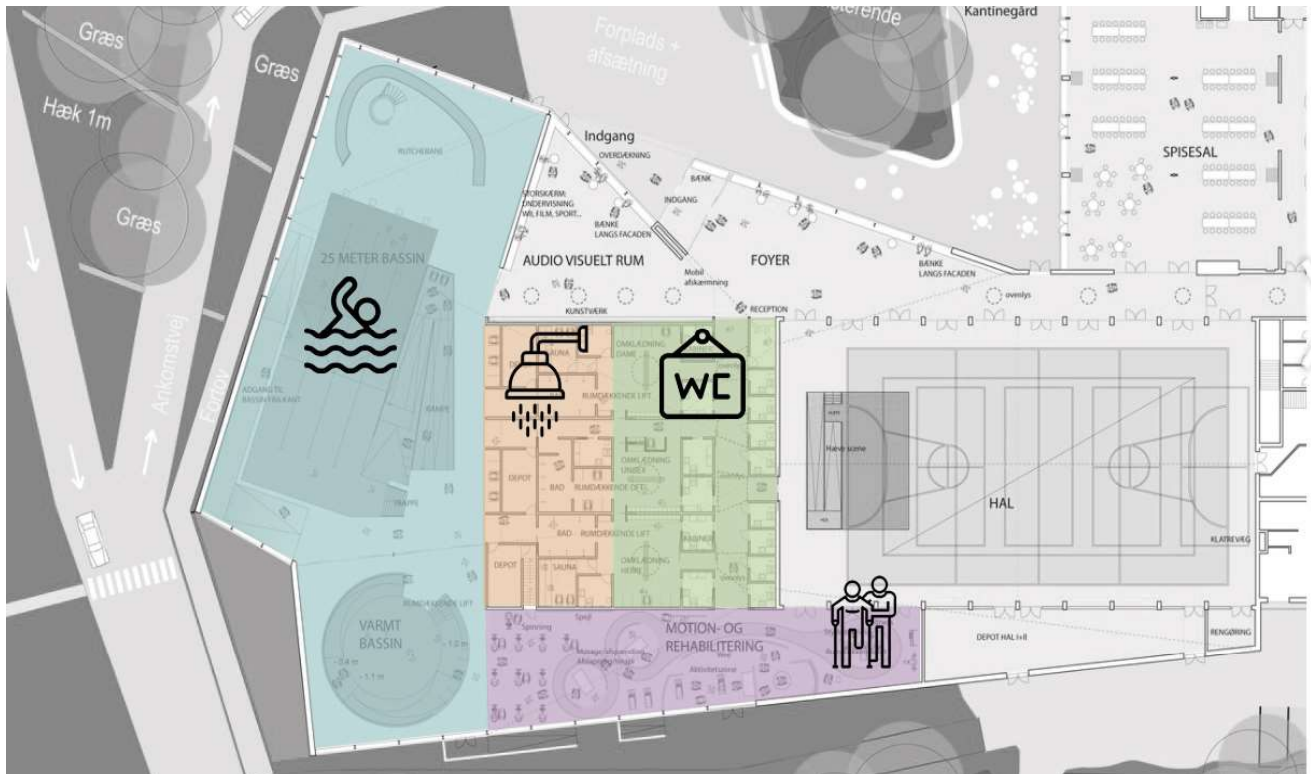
Planta arquitectónica de proyecto Centro de rehabilitación Vandhalla. CUBO ARKITEKTER, FORCE4 ARCHITECTS
